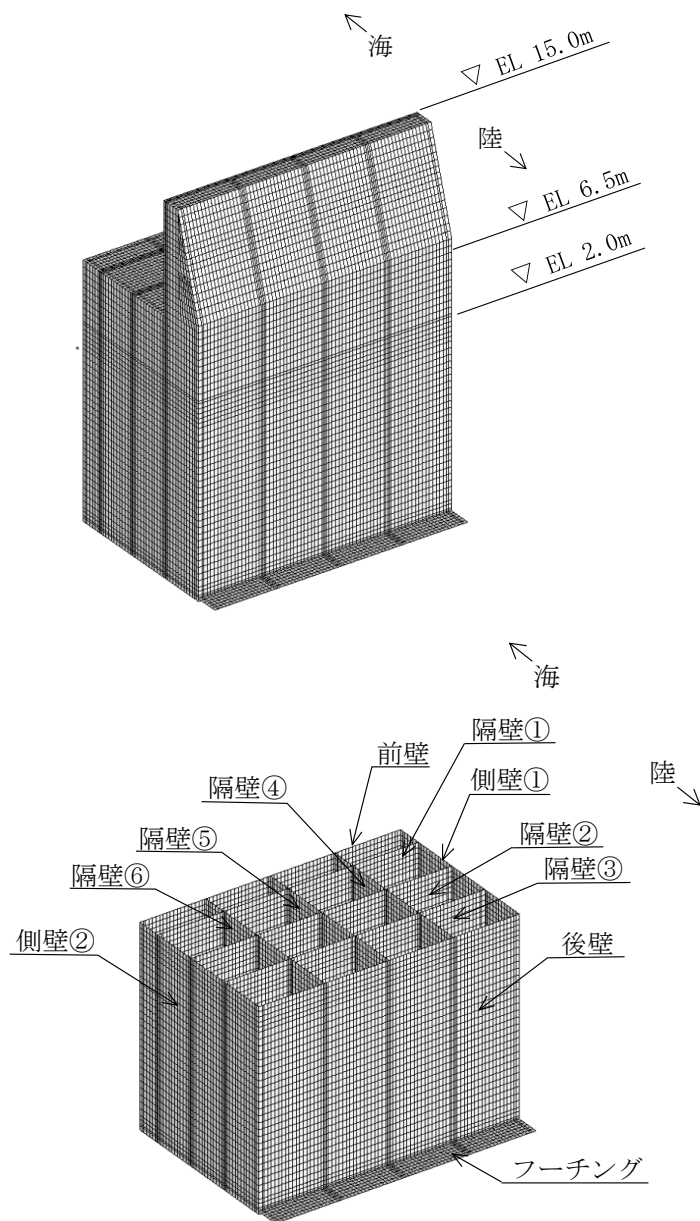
(1) 評価対象部材位置図 (②-②断面)
